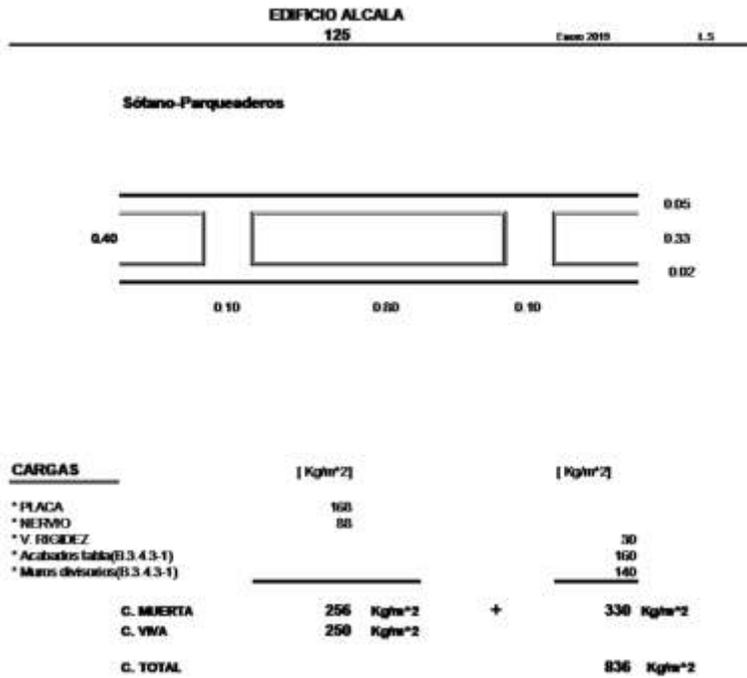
Análisis de cargas de la estructura-parqueaderos.
